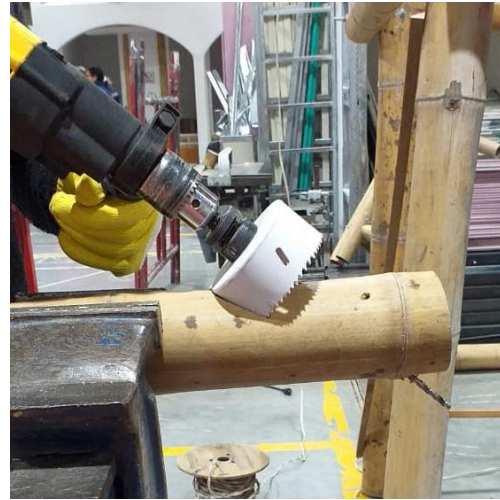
Proceso constructivo - paso 1 para Corte tipo flauta
